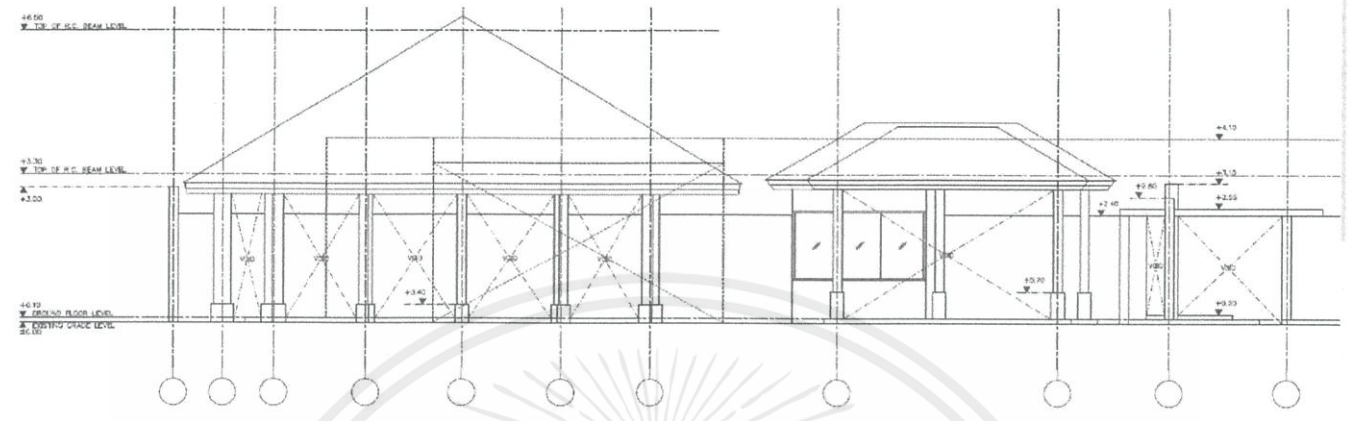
Elevation 1 (Leisure Spa & fitness)
